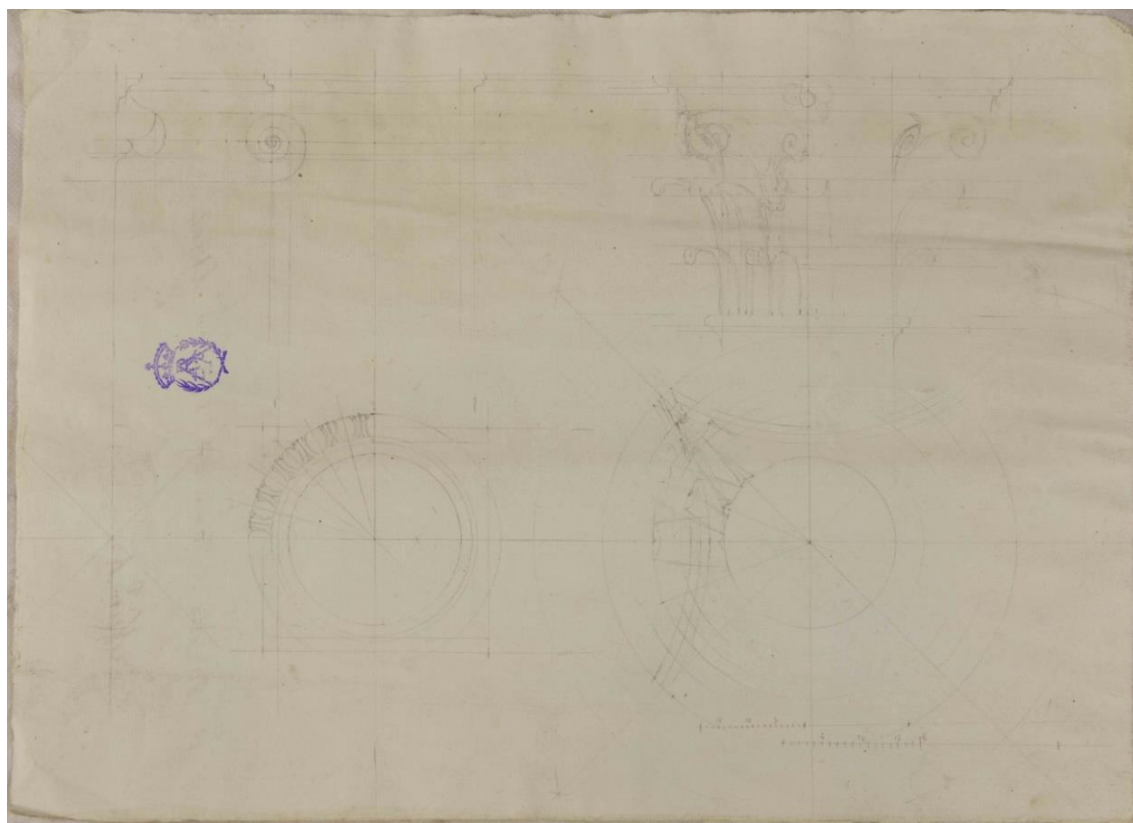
Dibujo A-5607: Planta y alzado del capitel jónico y corintio, Archivo R.A.B.A.S.F.
